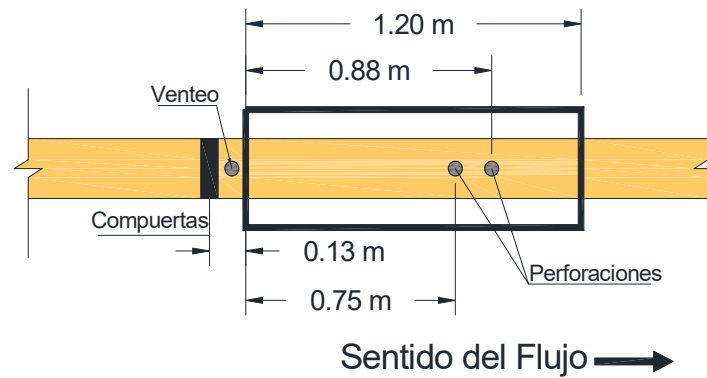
Ubicación del venteo y de las perforaciones para la sonda (vista en planta)
